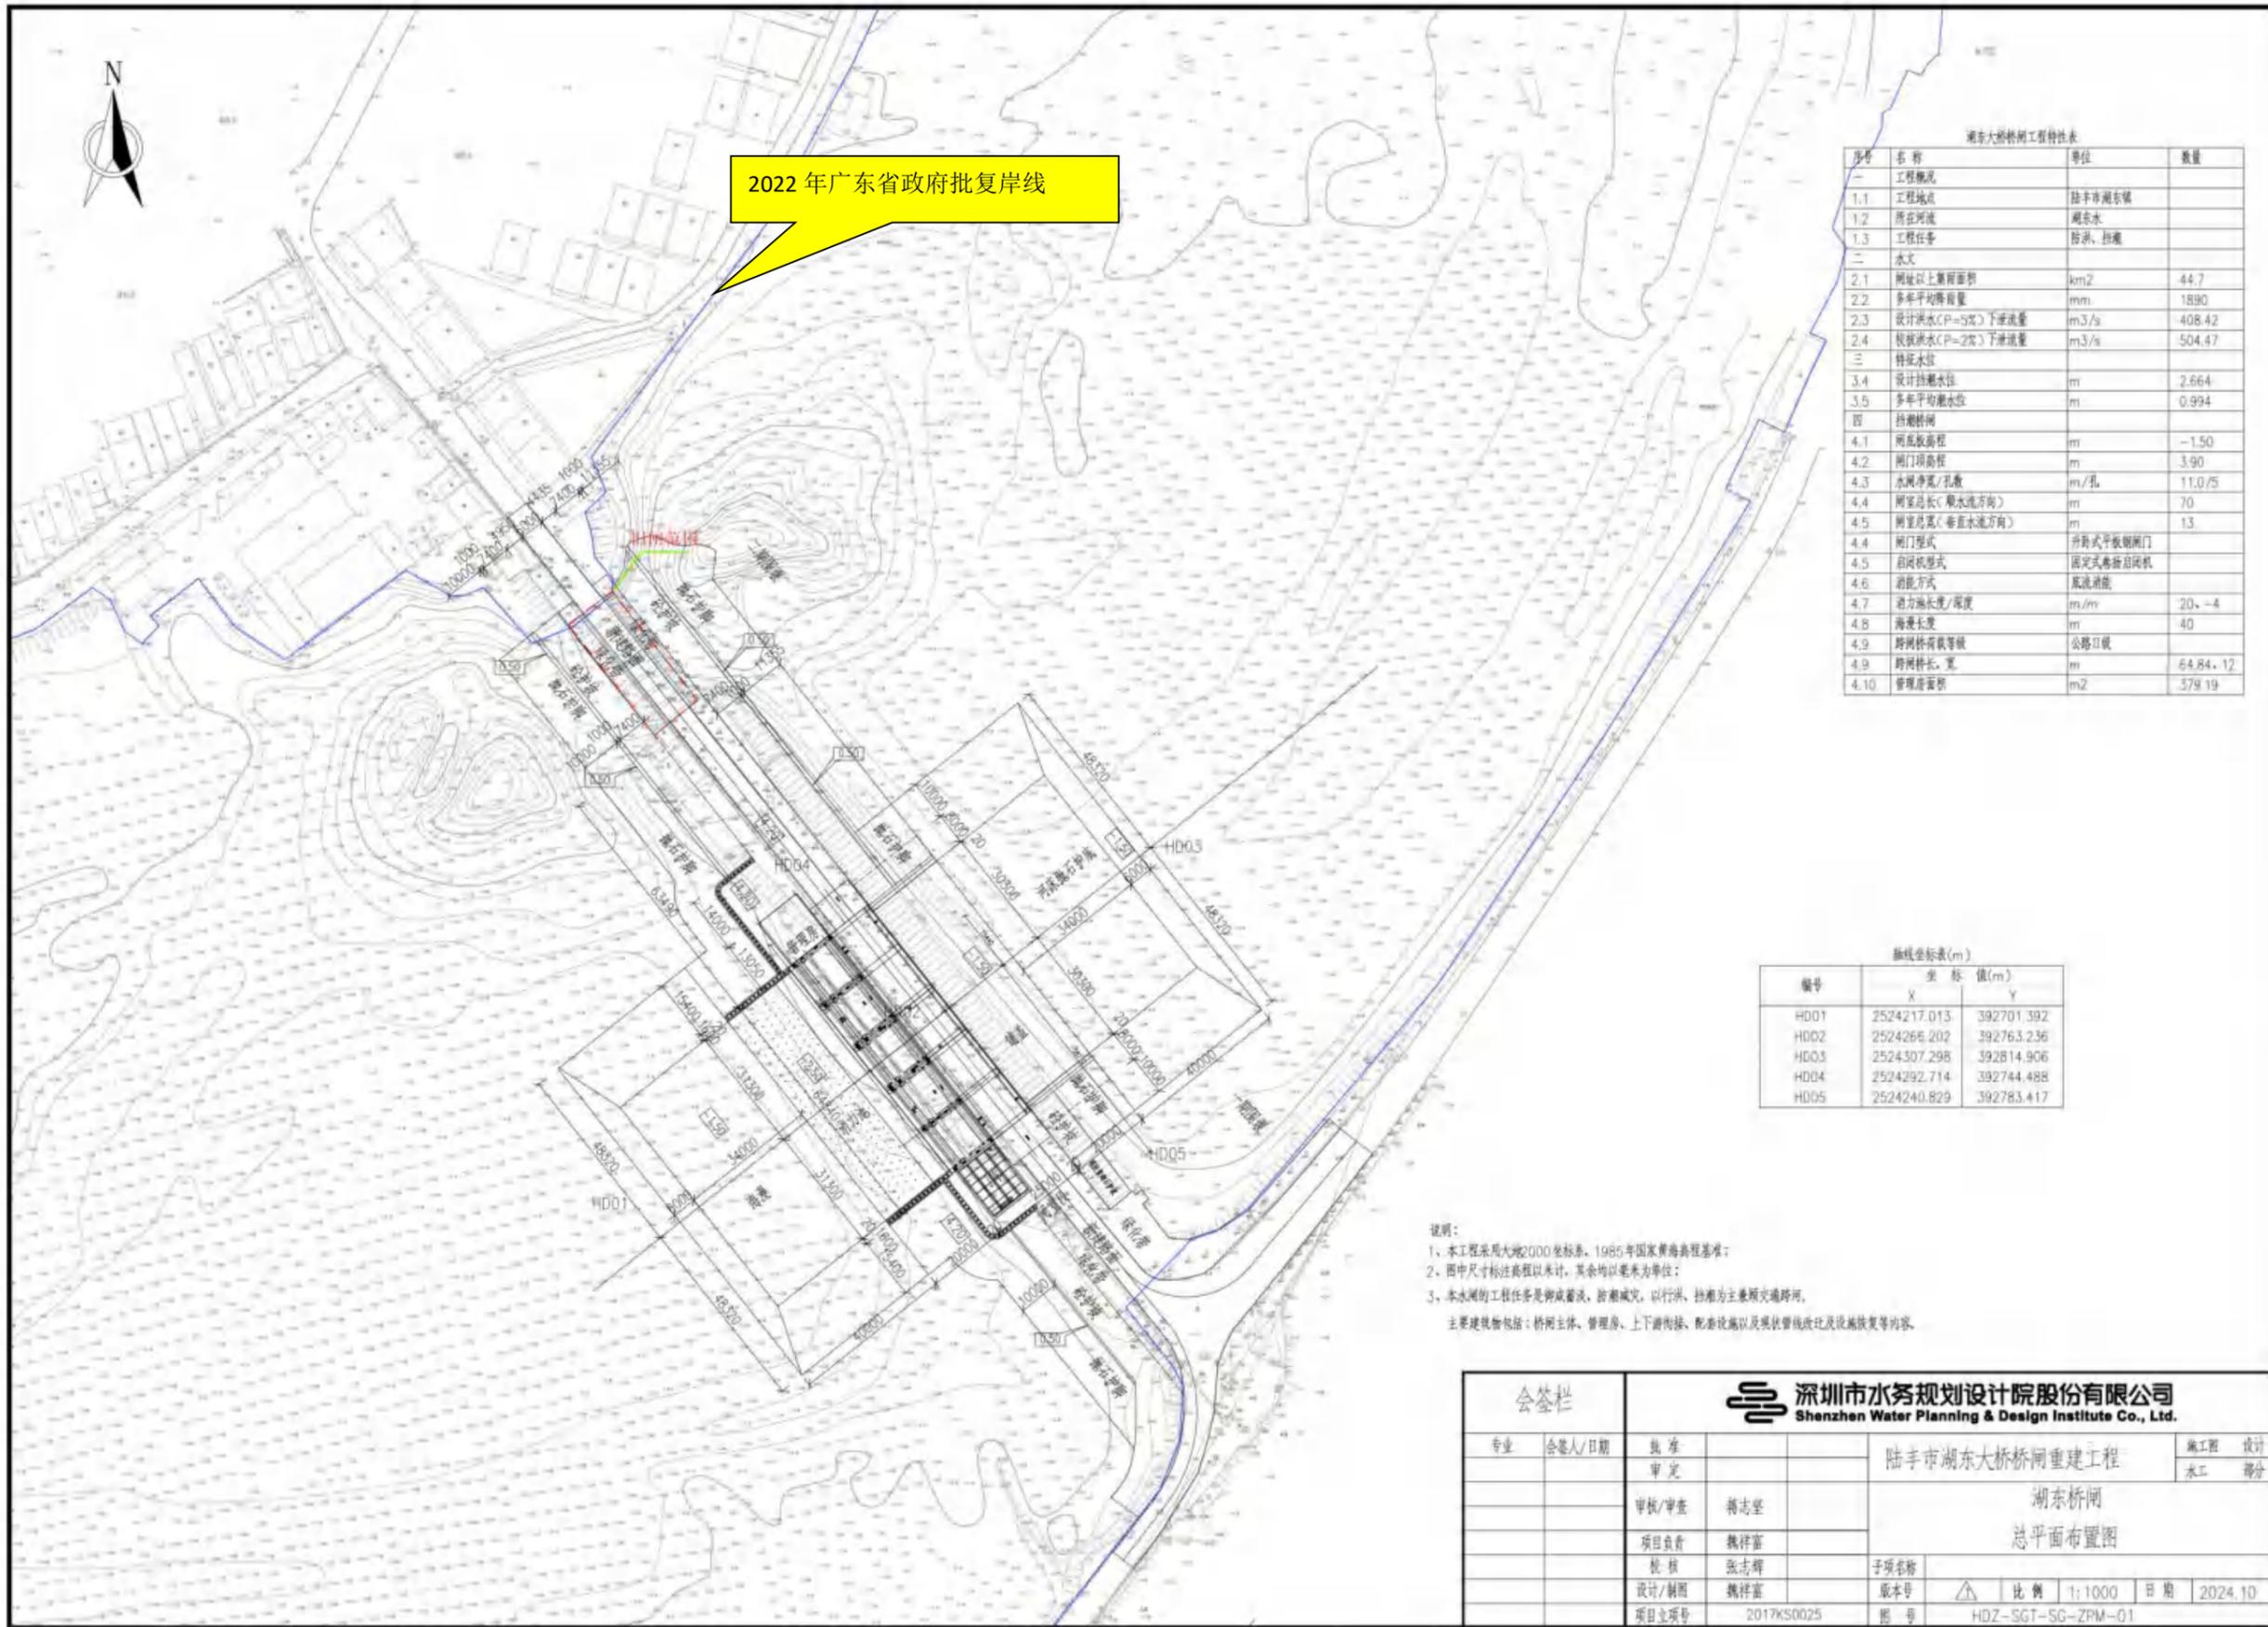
湖东大桥桥闸重建工程平面布置图
